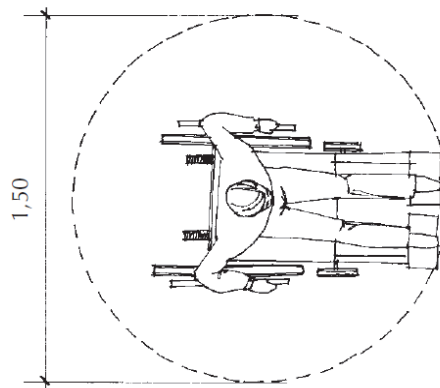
Espaço necessário para giro completo de 360° (SMPED, 2008).
